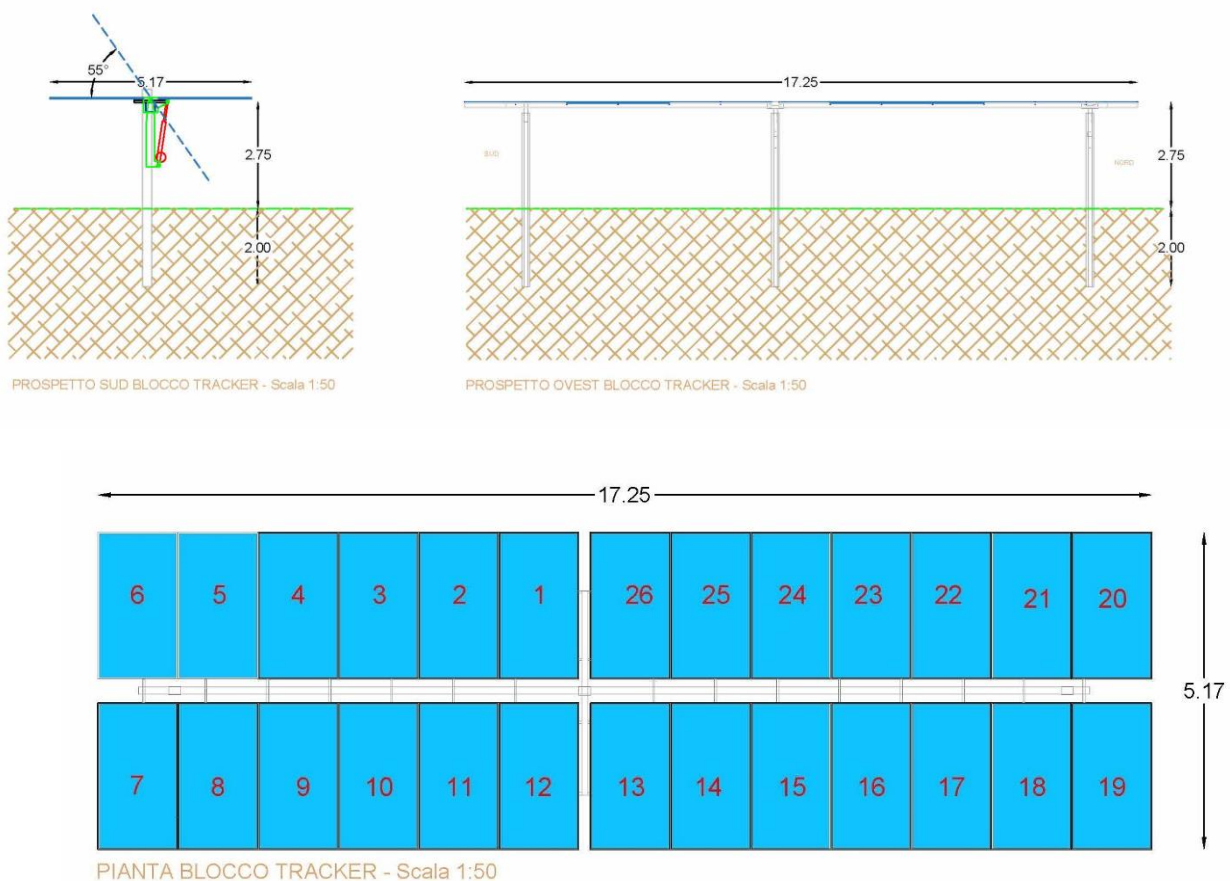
Tipologico struttura sostegno moduli – sezioni e planimetria
